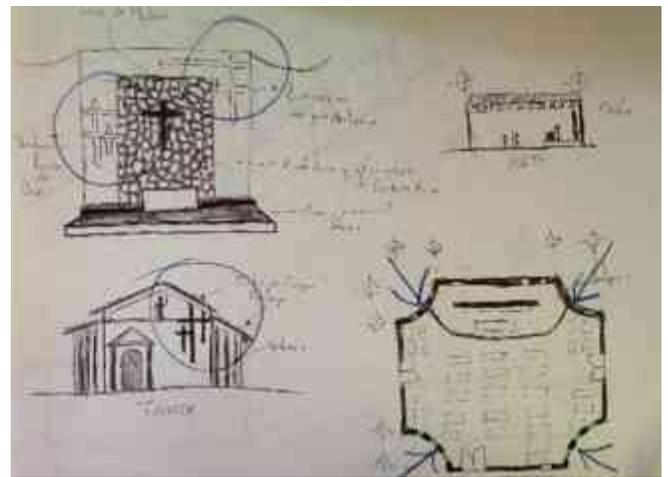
“Propuesta en planta, fachada y corte de la capilla así como una propuesta de presbiterio”
